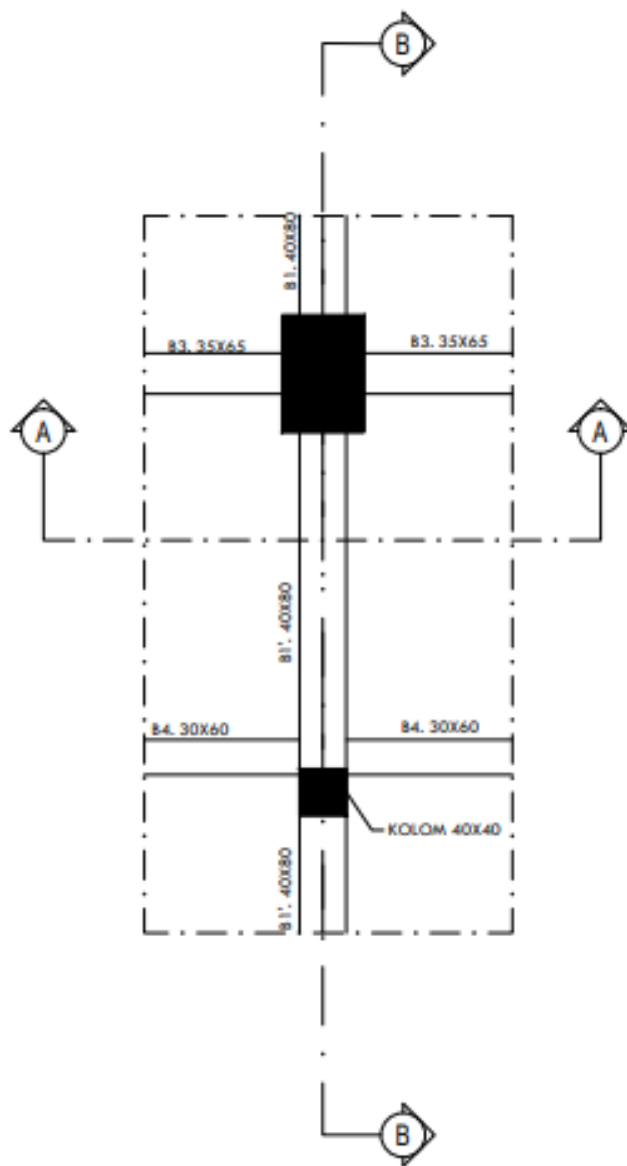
Detail Rencana Balok Lantai Elv. + 4.68
